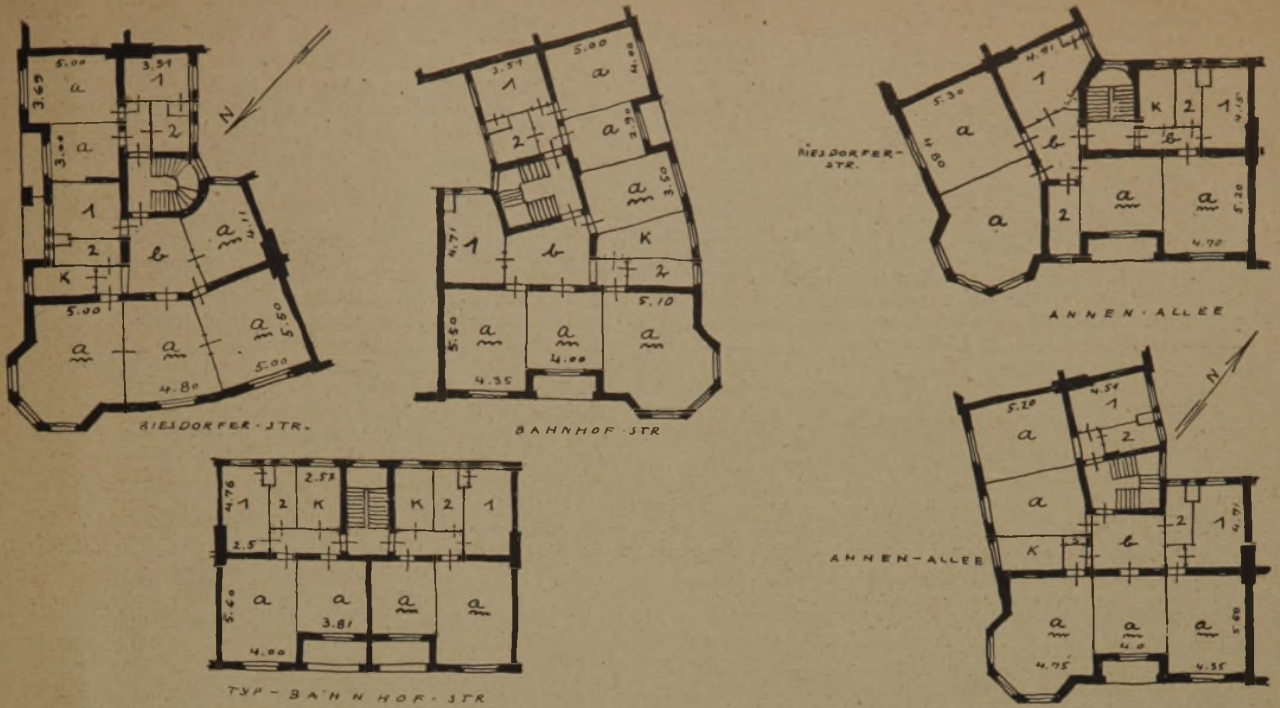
bis 19. Grundrisse der 4 Ecken und eines Mittelstücks zu Bauteil X. (Bild Abb. 1, S. 425.) (1 : 400.) Zu Lageplan Abb. 20.
